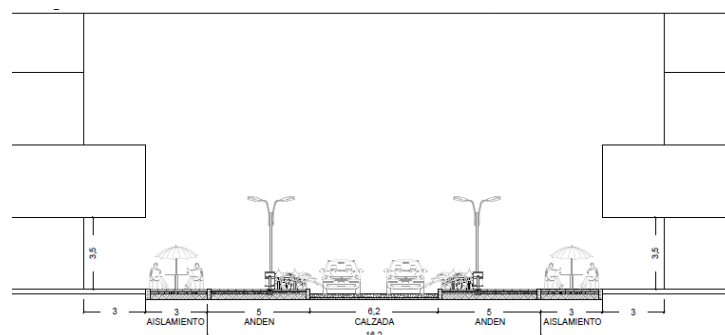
Perfil vial propuesto para las vías tipo V3.
